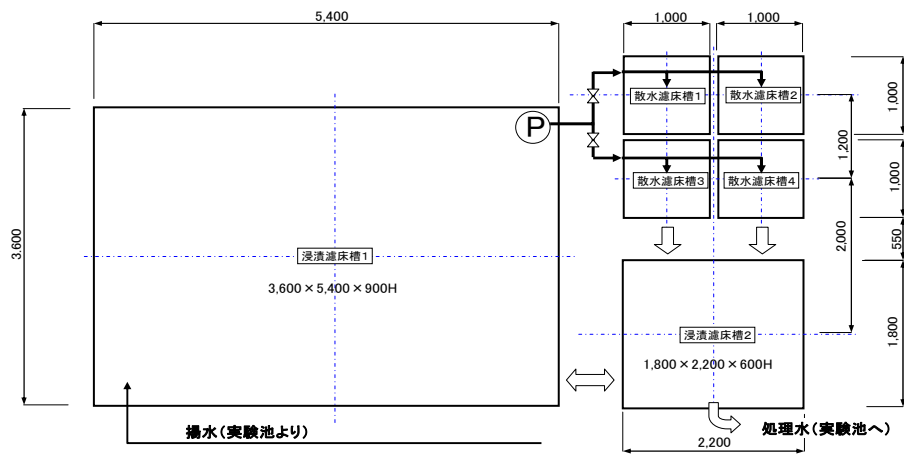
3 試験設備の平面図 (平成 1 9 年)
